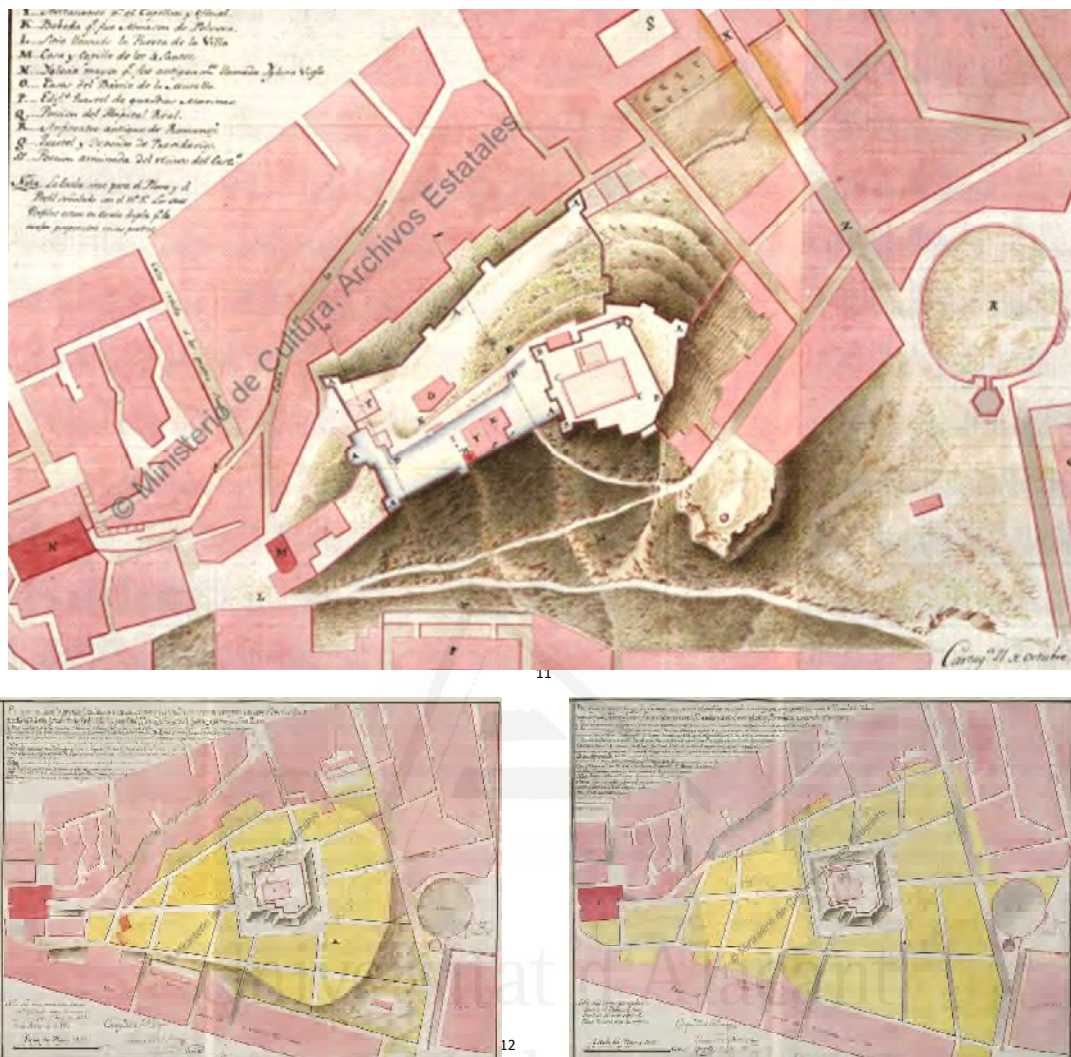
Planos del cerro de Concepción en su estado a finales del siglo XVIII, y los proyectos de remodelación no llevados a cabo.
